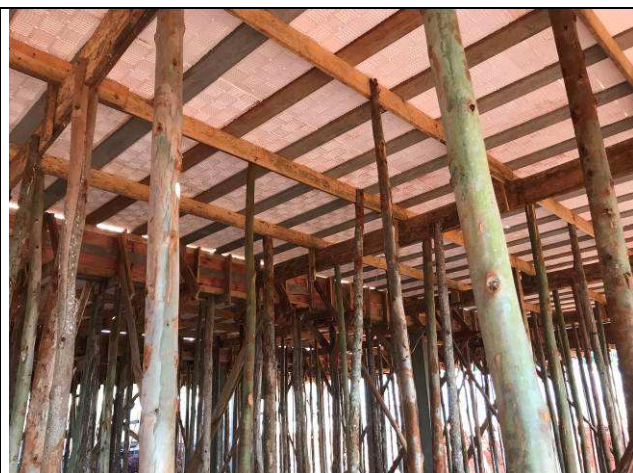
C: Laje e vigas de cobertura do prédio principal - eixos 1-5 e G-I.
